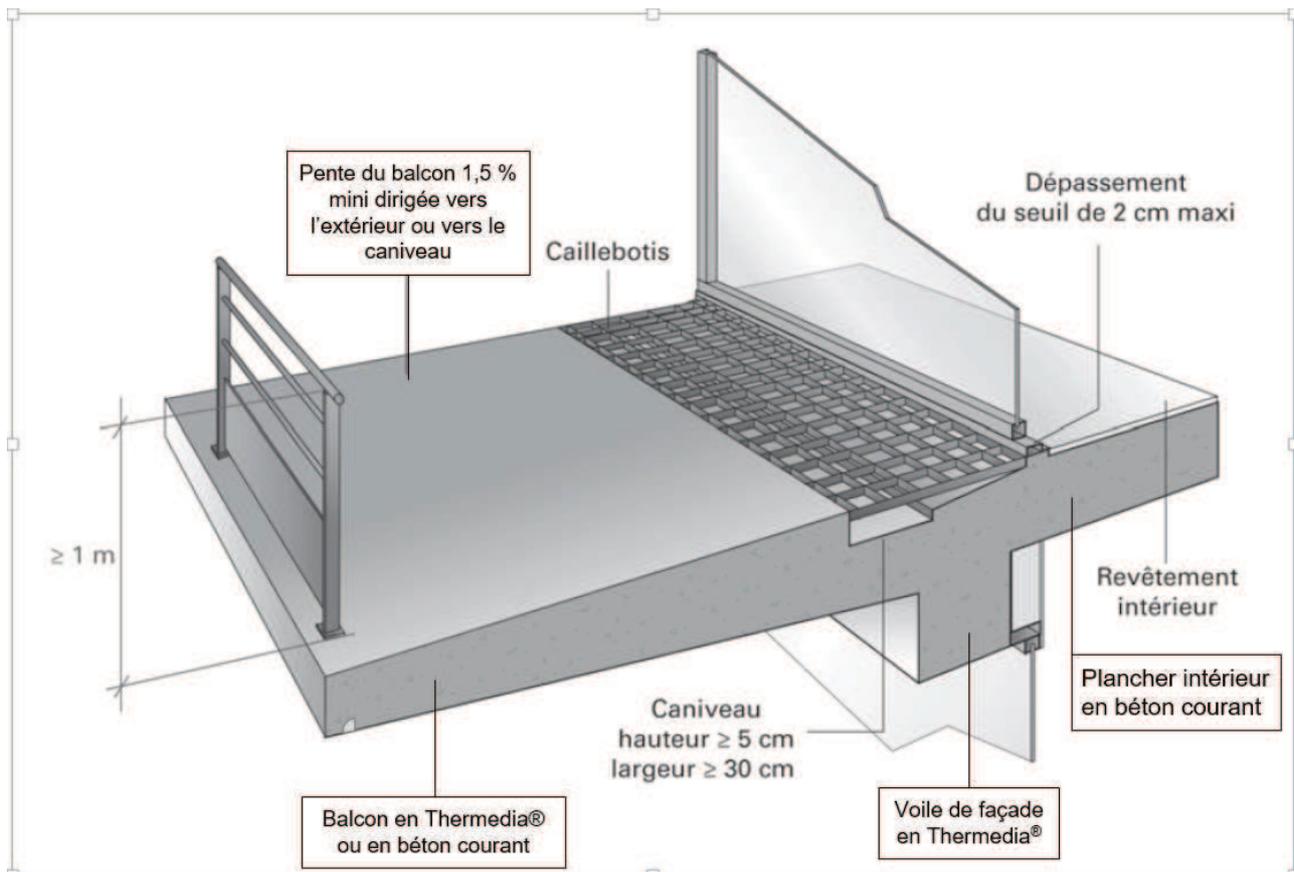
Exemple de balcon, loggia ou coursive sans revêtement d'étanchéité – Garde d'eau assurée par un caniveau
